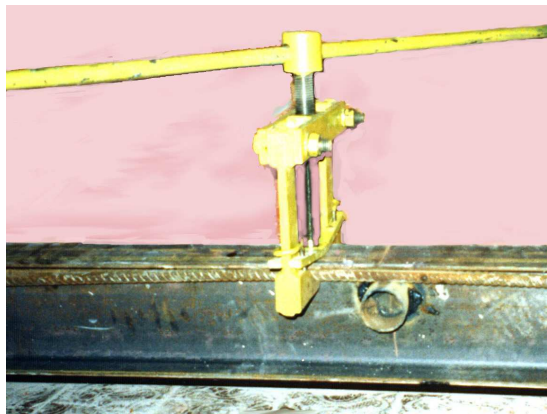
Локальное предварительное напряжение стальной балки до монтажа непосредственно на объекте (в перевернутом положении)
